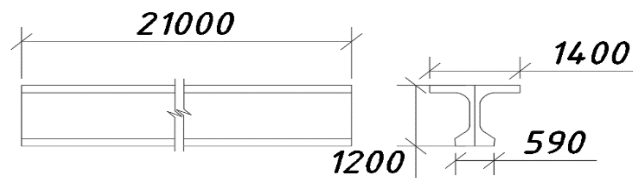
Попередньо напружена залізобетонна балка 21 м
